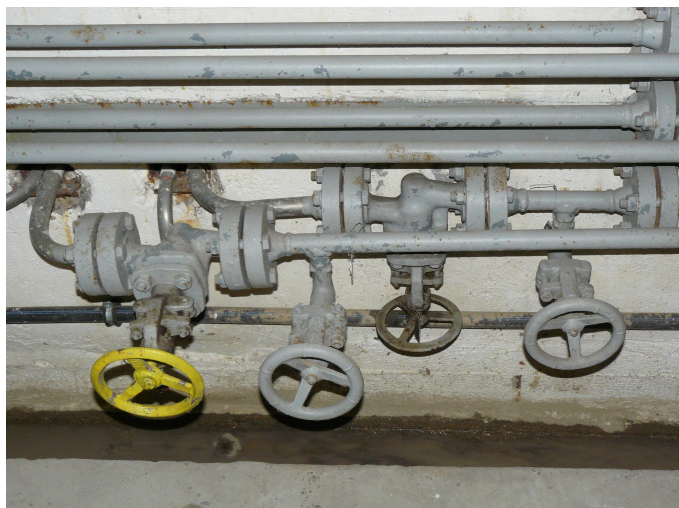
Stávající uzávěry na hydraulickém potrubí
